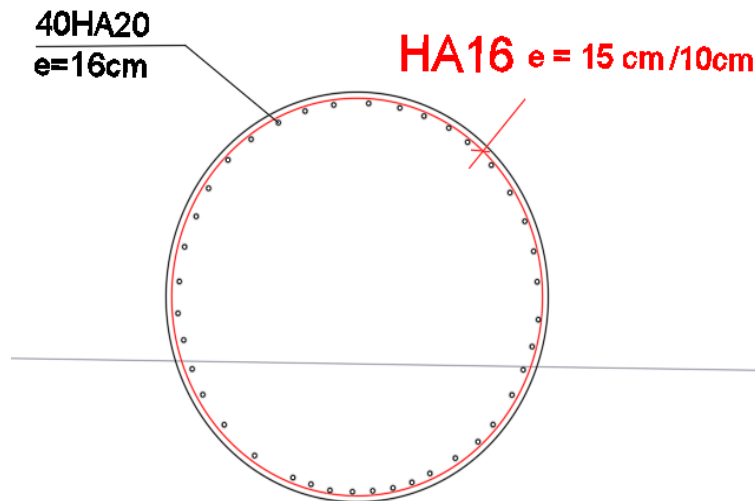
ferrailage d'un fut de la pile 2
